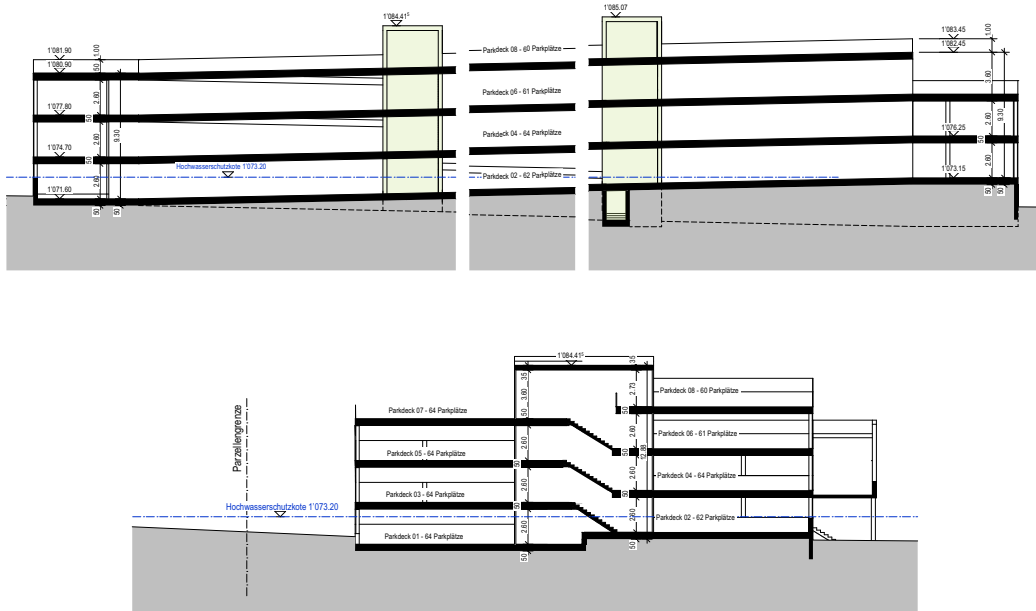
Längsschnitt und Querschnitt durch das Parkhaus Variante 14, Stand Mai 2022 © Brügger Architekten Thun
